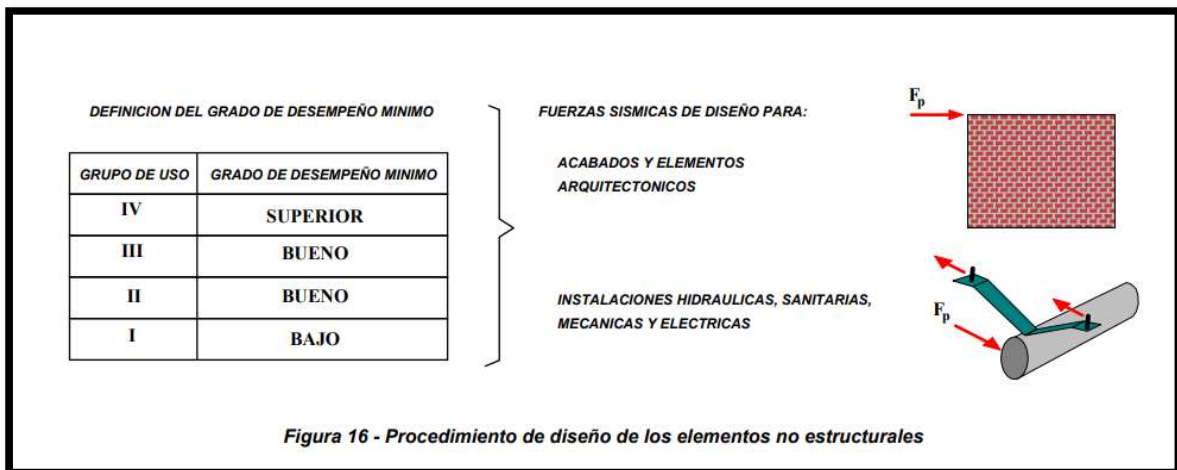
Elementos no estructurales. Fuente: NSR 10 Tomo 1, Prefacio i, p. xxxviii.
